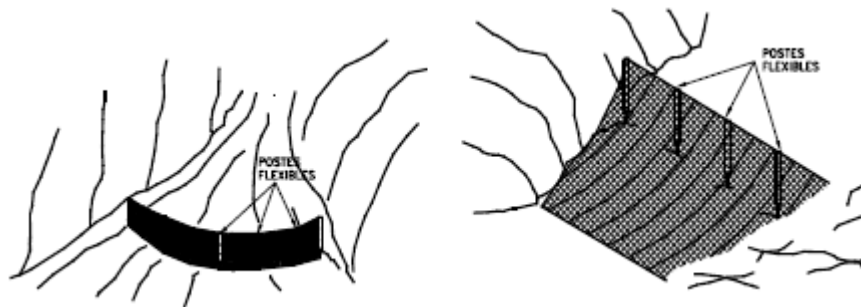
Barreras de tierra armada con geotextil para protección contra caídos y avalanchas.
